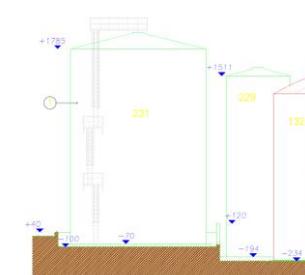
Estratto Tavola 02: Pianta, prospetti e sezioni
